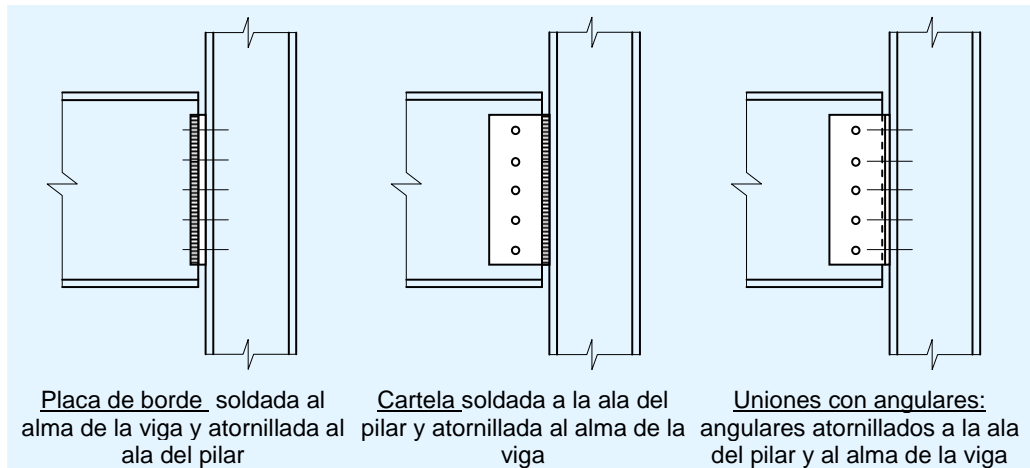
Uniones típicas de viga-pilar – uniones articuladas
